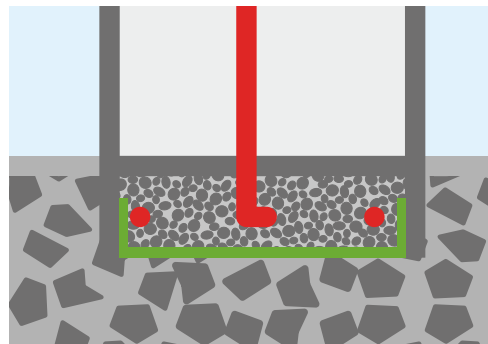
Einbau Radondrainage mit zusätzlicher Magerbetonschicht (grün) bei hochdurchlässigen Böden.
